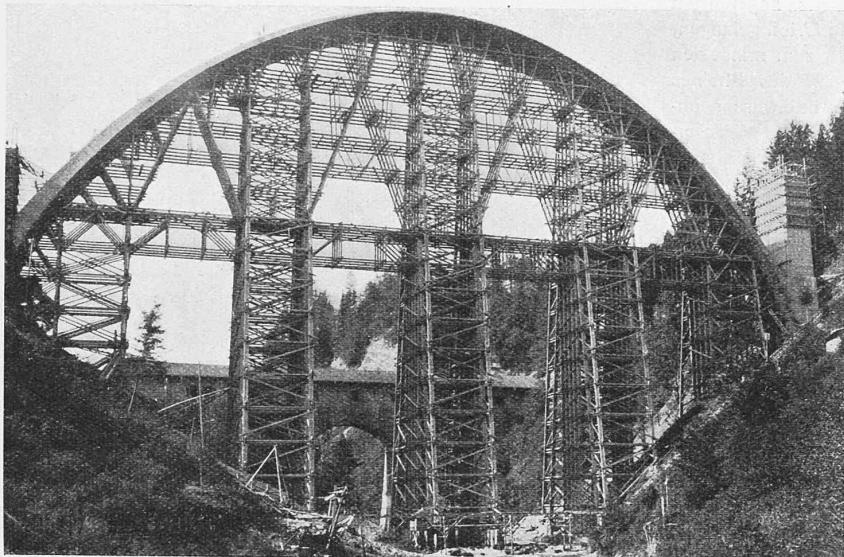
Lehrgerüst der Hundwilertobel-Brücke, Entwurf und Ausführung Ed. Züblin & Cie. (Zürich).
